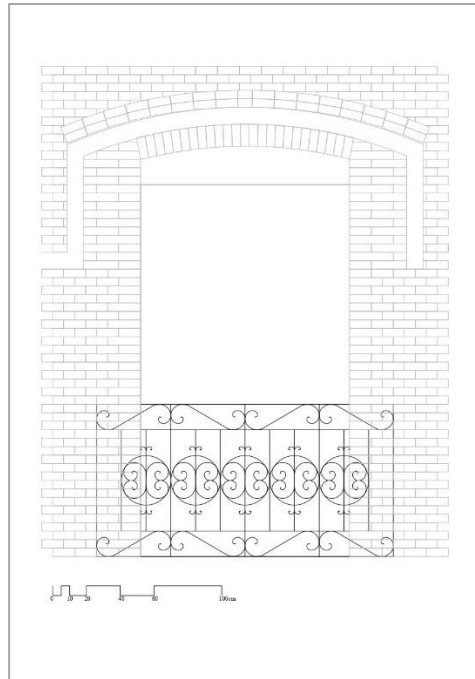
Balcón de la primera planta del edificio de la avenida de la Albufera 56. Elaboración propia.
